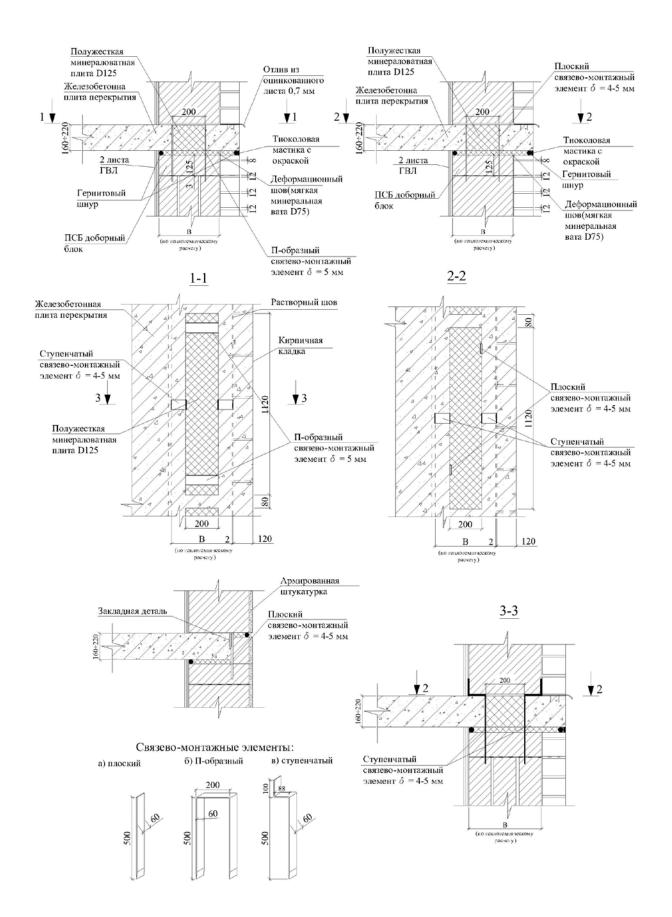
Крепление кладки из ПСБ блоков к железобетонным перекрытиям 50
